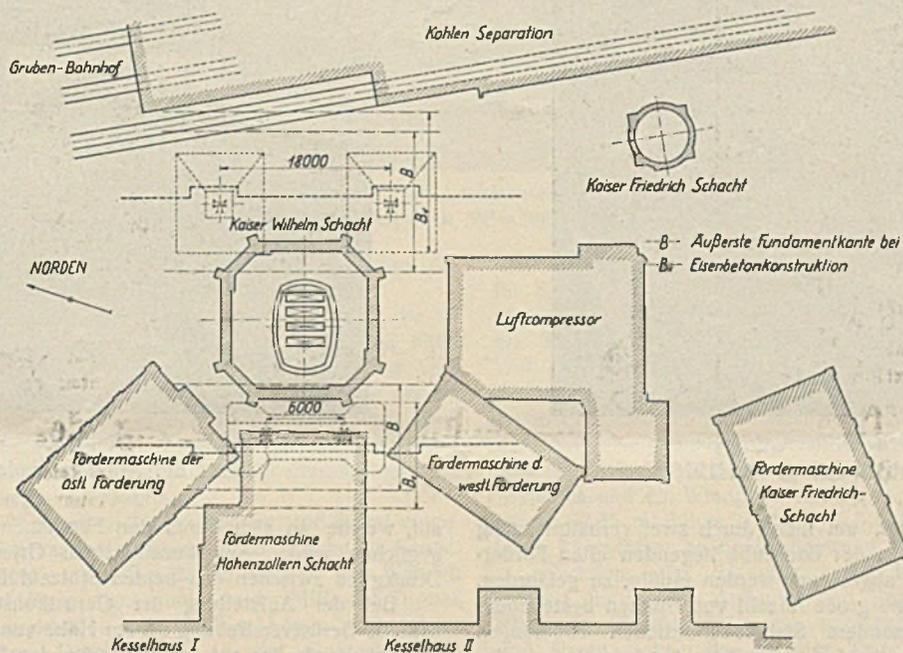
Grundriß des Kaiser-Wilhelm-Schachtes (Heft 2, 1928, S. 16, Abb. 1).
